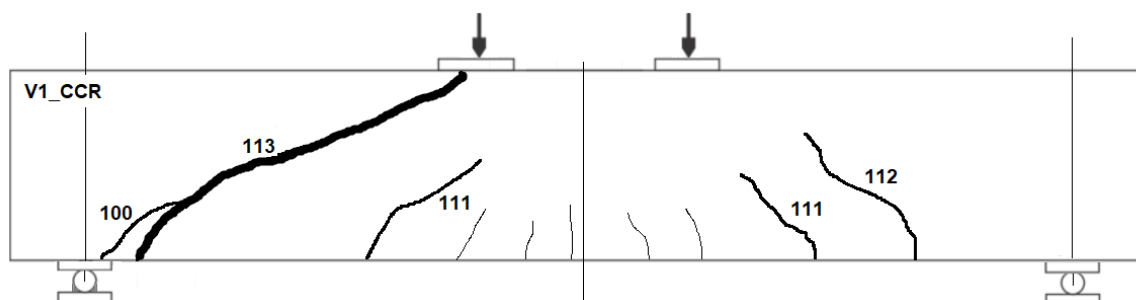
Esquema de fissuração da Viga 1_CCR.
